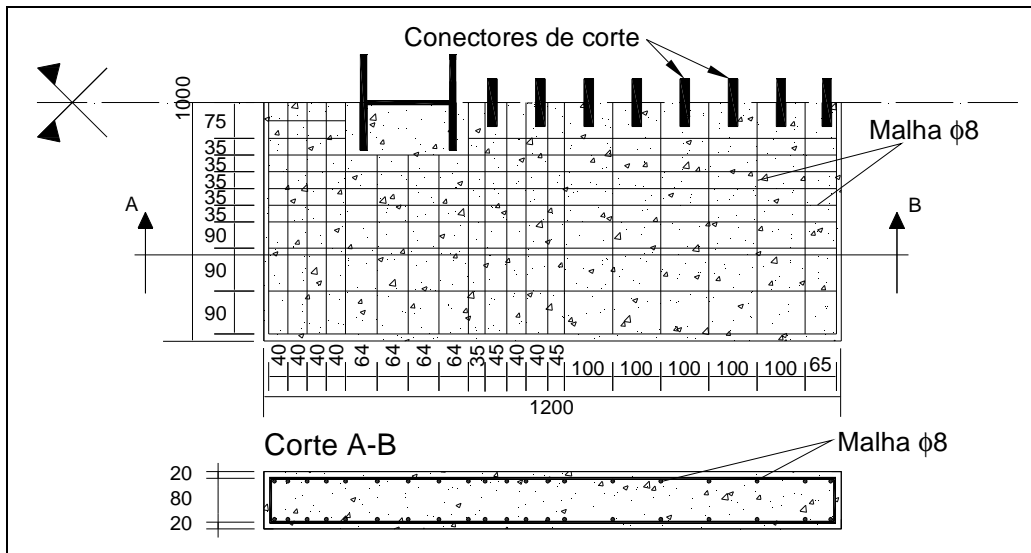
Planta e corte da laje de betão que constitui as ligações WW-CB, TSW-CB, WW-CBC e TSW-CBC.
